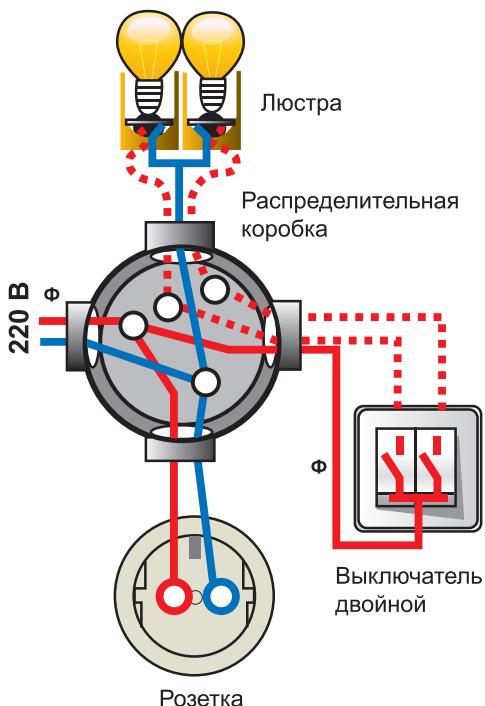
Соединение проводов внутри распределительной коробки, когда питание розеток и освещения идет от одного общего кабеля
